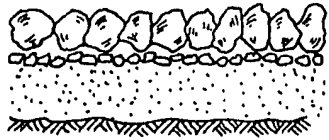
Revestimiento de mampostería (sin mortero)
